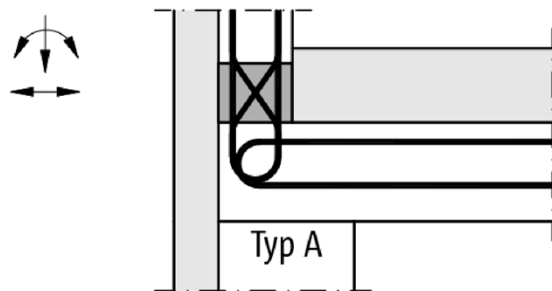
Schöck Isokorb® Typ H, Ergänzung für Horizontallasten senkrecht und parallel zur Dämmfuge
